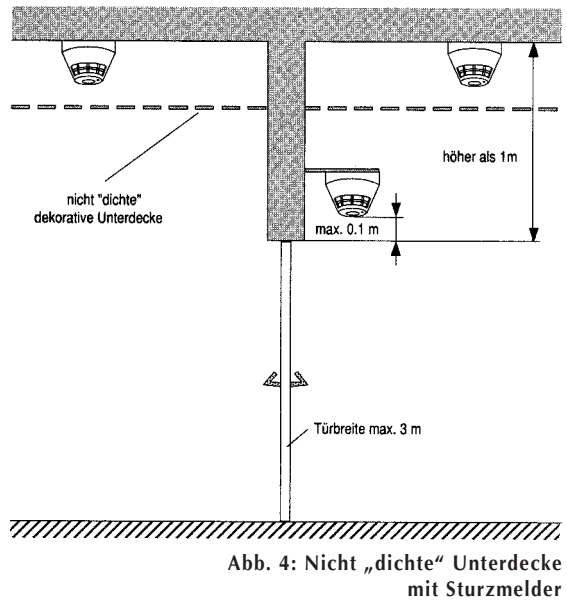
Nicht „dichte“ Unterdecke mit Sturzmelder
